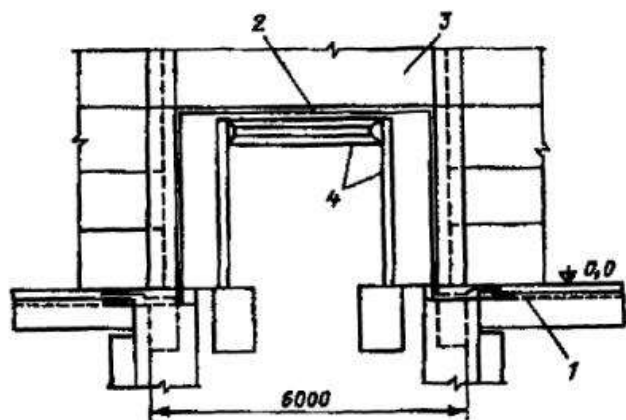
Соединение арматуры фундаментных балок в местах проемов:
